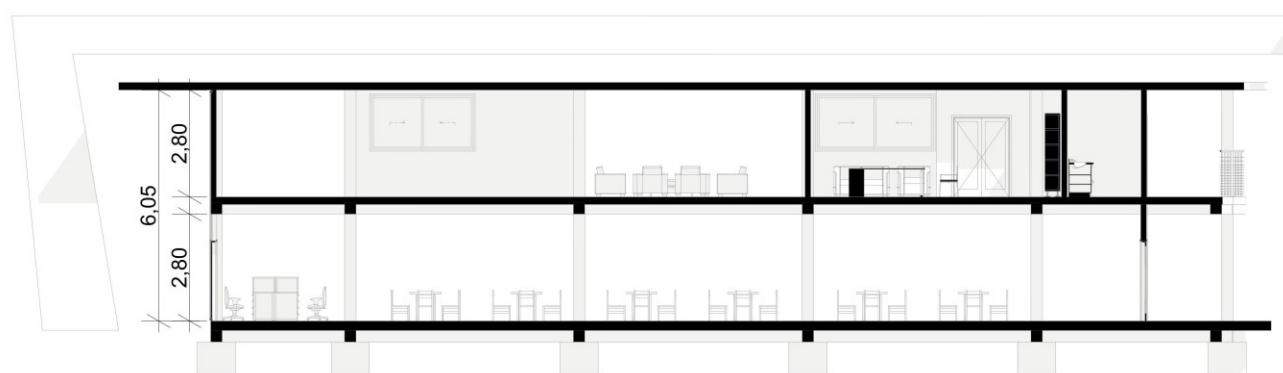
Corte fachada frontal-bloque A / Fuente: Propia
